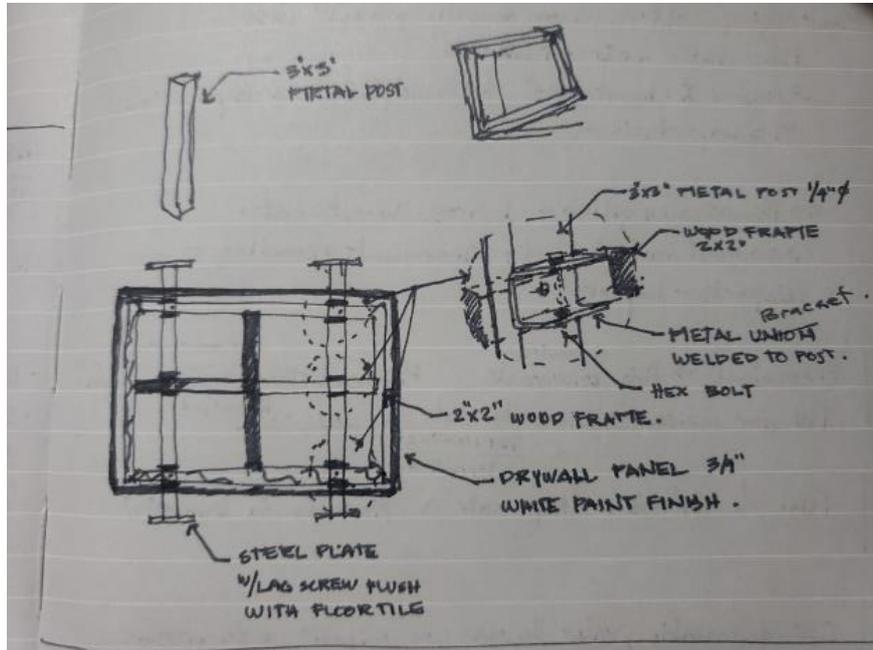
Boceto a mano de detalle constructivo esquemático. Fuente: elaboración propia.
